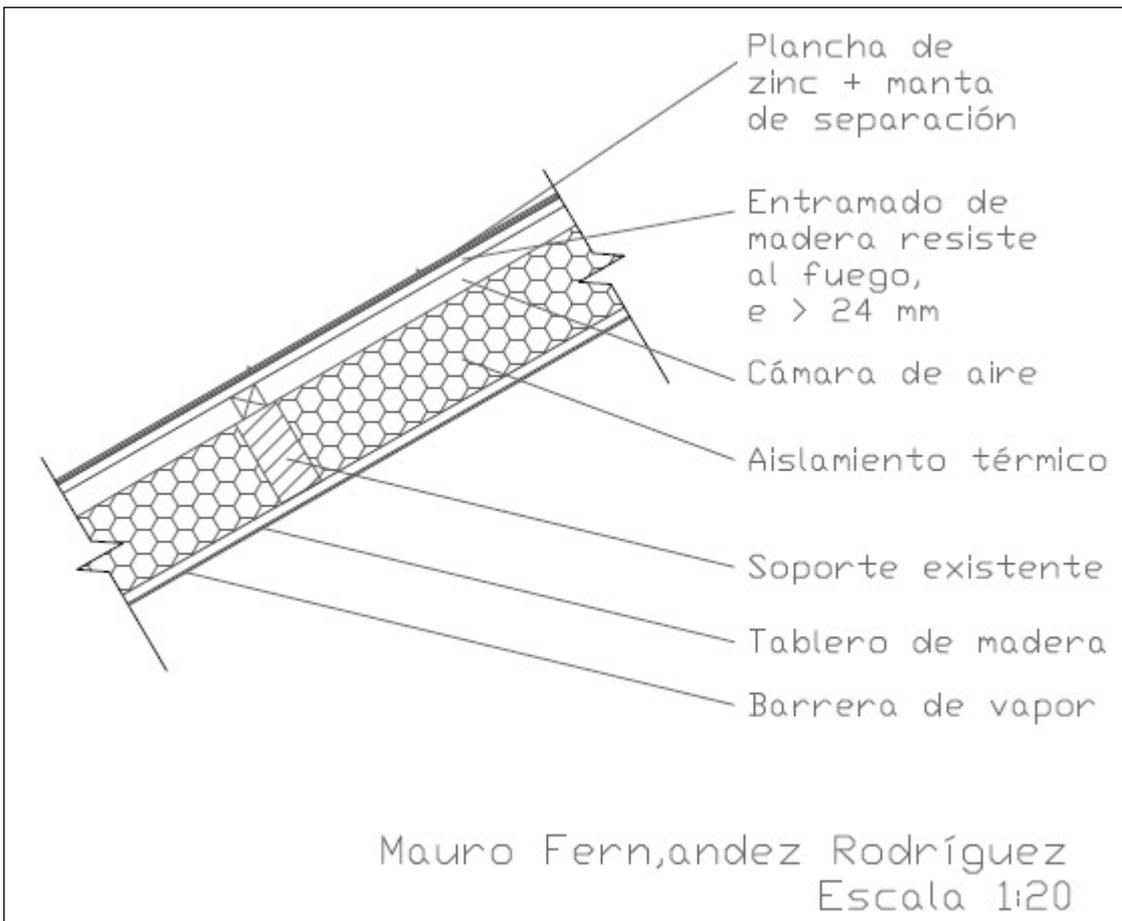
Sección cubierta zinc ventilada, fuente:
